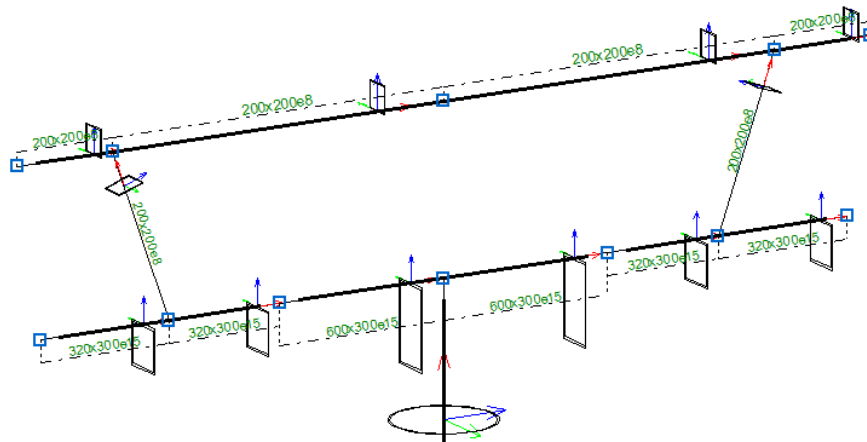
Modelizado tipo de una potencia y sobrepotencia para ancho de vía de 6,4 m
